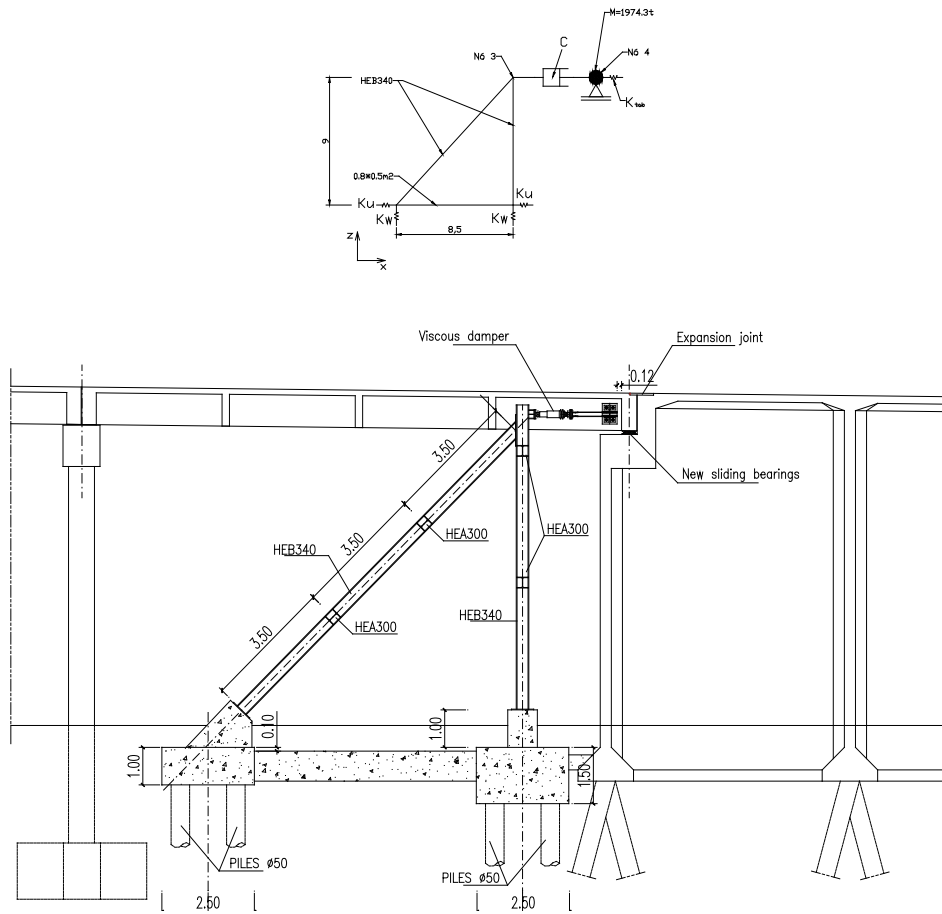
Introdução de amortecimento sísmico e vista geral do viaduto após reabilitação
